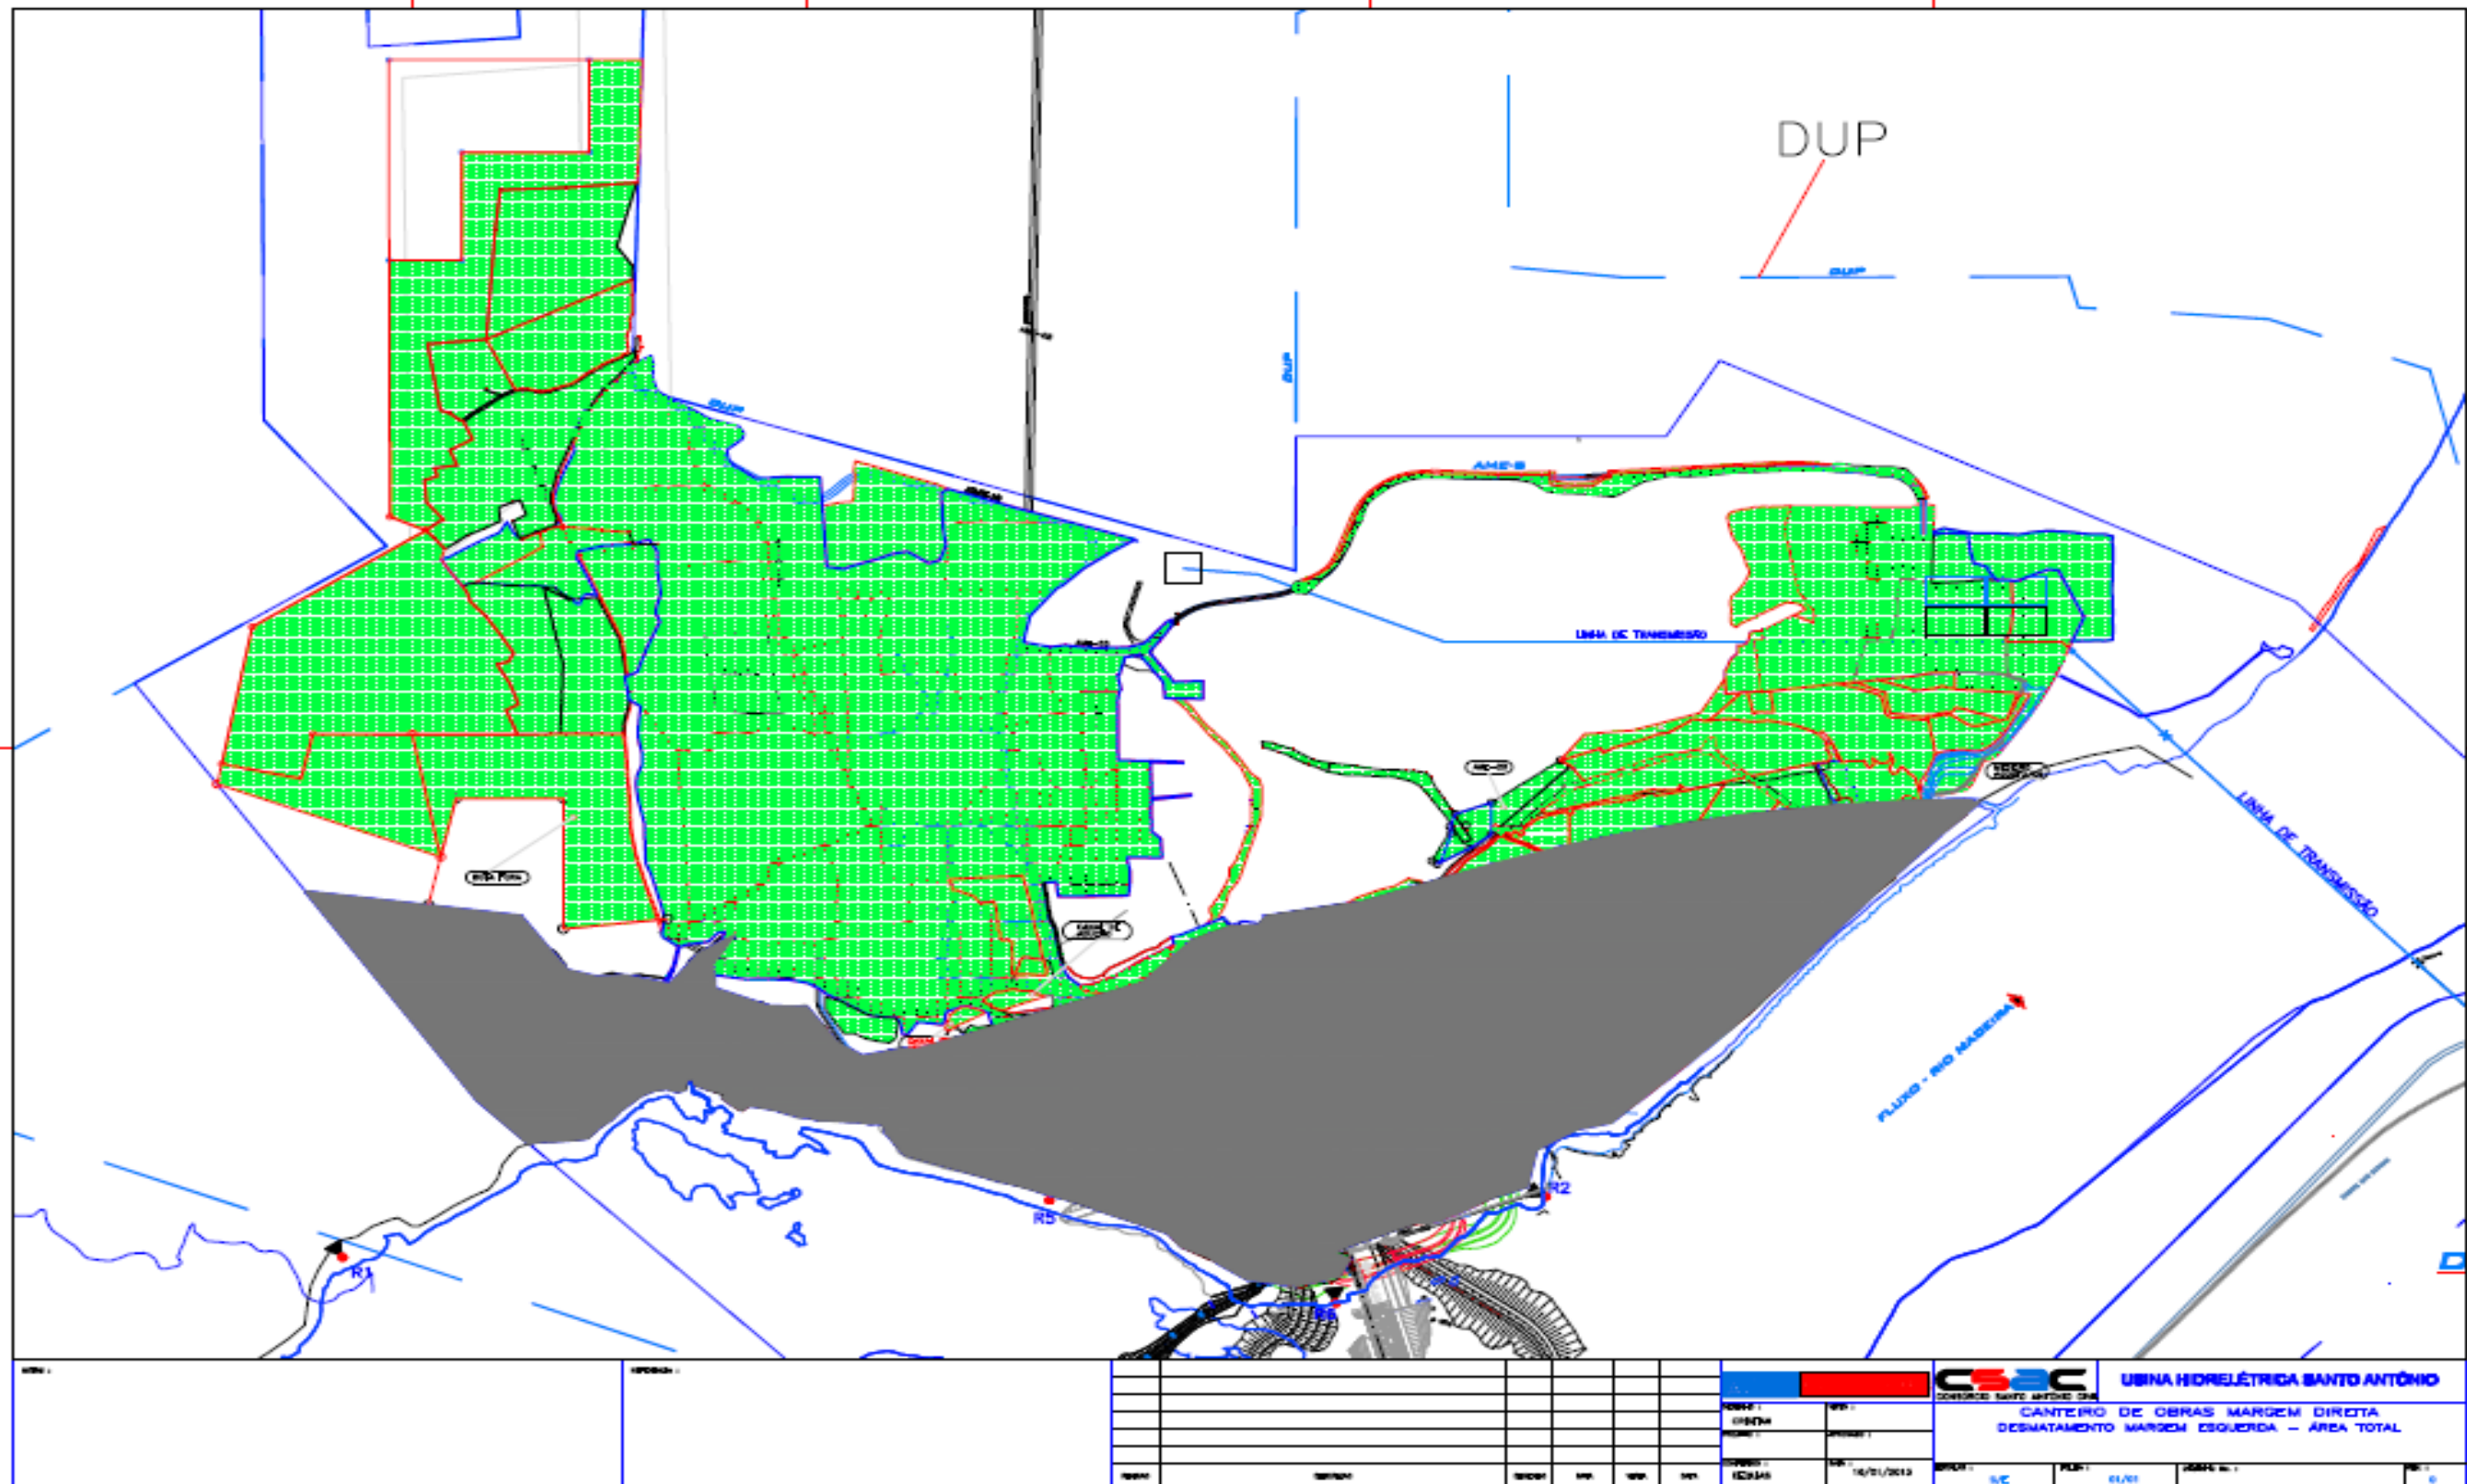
11 - Planta da margem esquerda do canteiro de obras com a área revegetada até o mês de janeiro de 2013.
